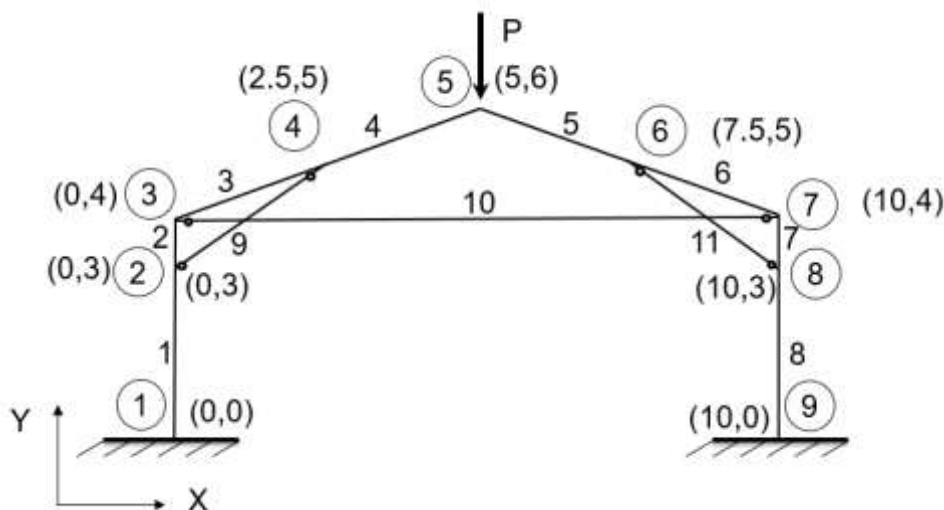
Entramado de 11 barras doblamente empotrado en los nodos 1 y 9, con las barras 9, 10 y 11 articuladas internamente al pórtico.
